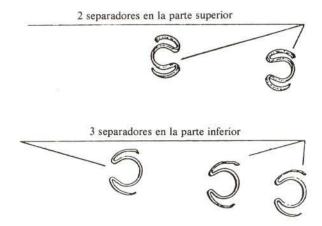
Esta es la colocación que deben llevar los separadores
